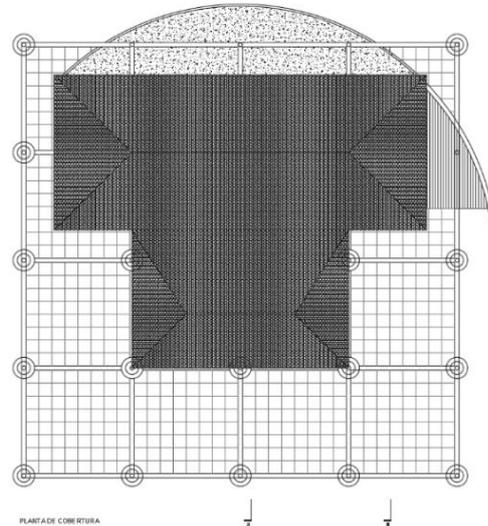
Planta de Cobertura. Fonte: Paulo Amorim Arq. (2022)
